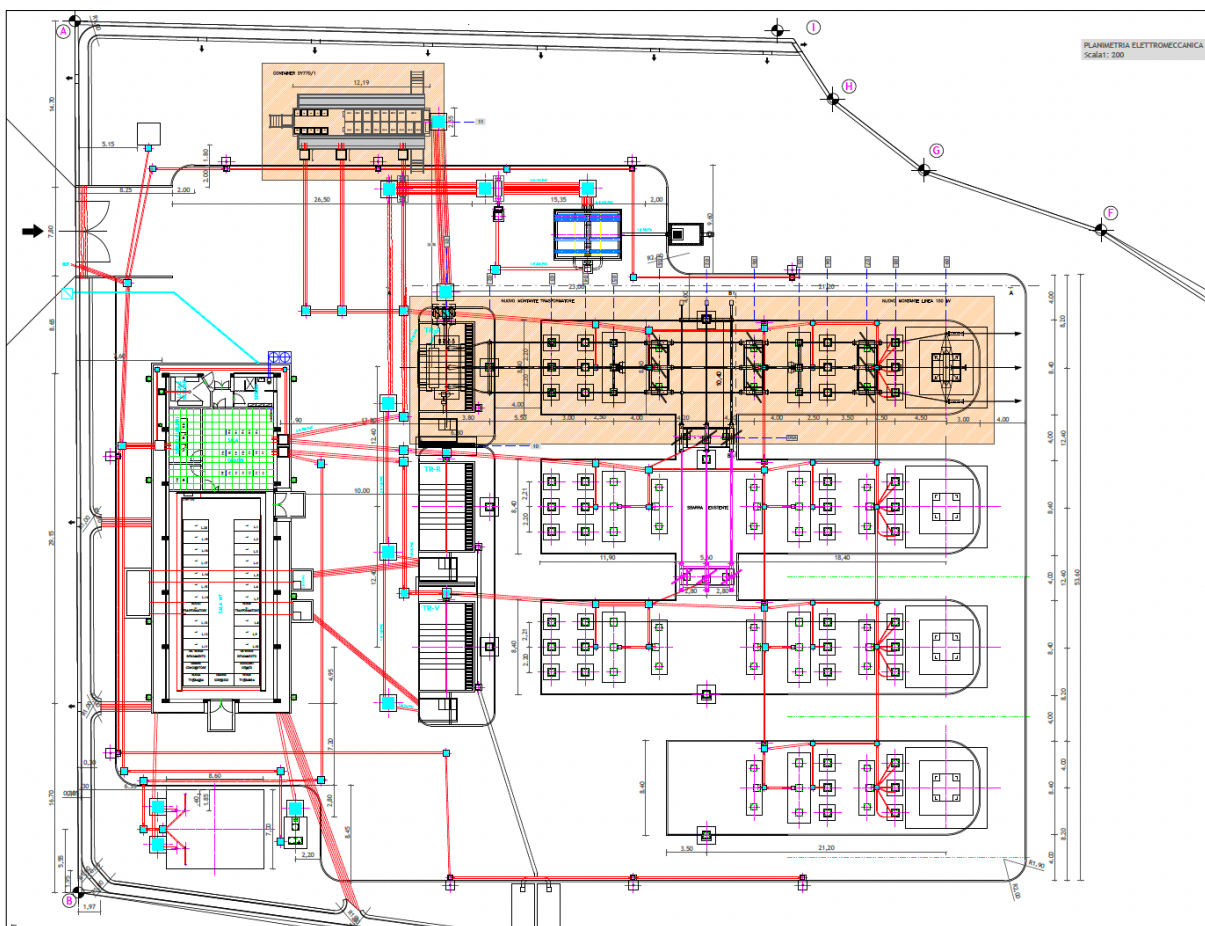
Stralcio planimetrico delle opere di potenziamento della CP di Gissi
